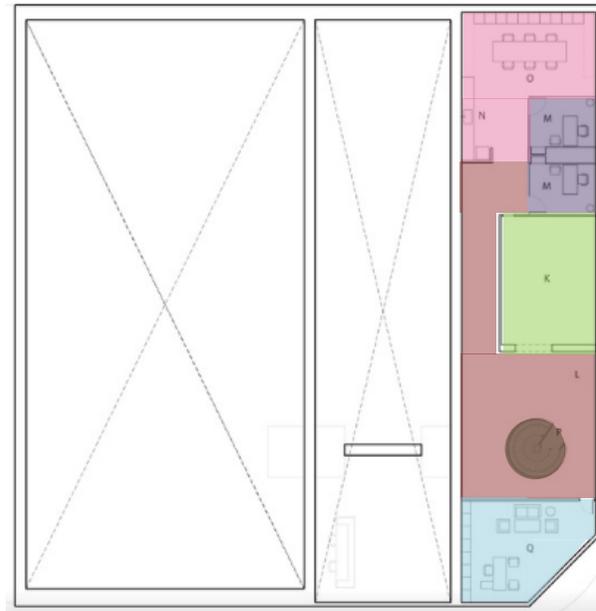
Planta baixa superior - Fonte: Archdaily, 2019
